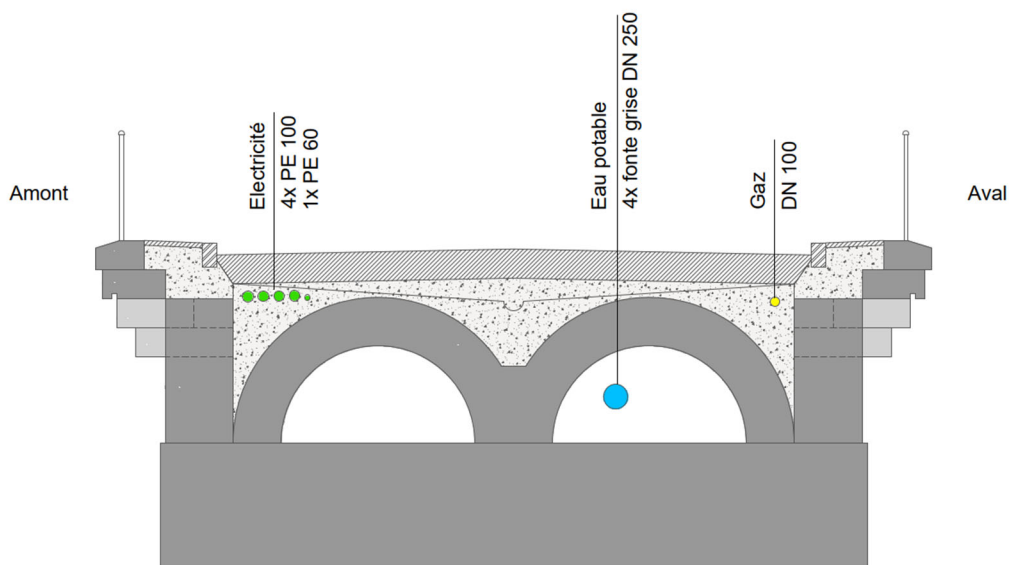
Coupe transversale à la clé de voûte du pont de Brent avec les conduites industrielles existantes
